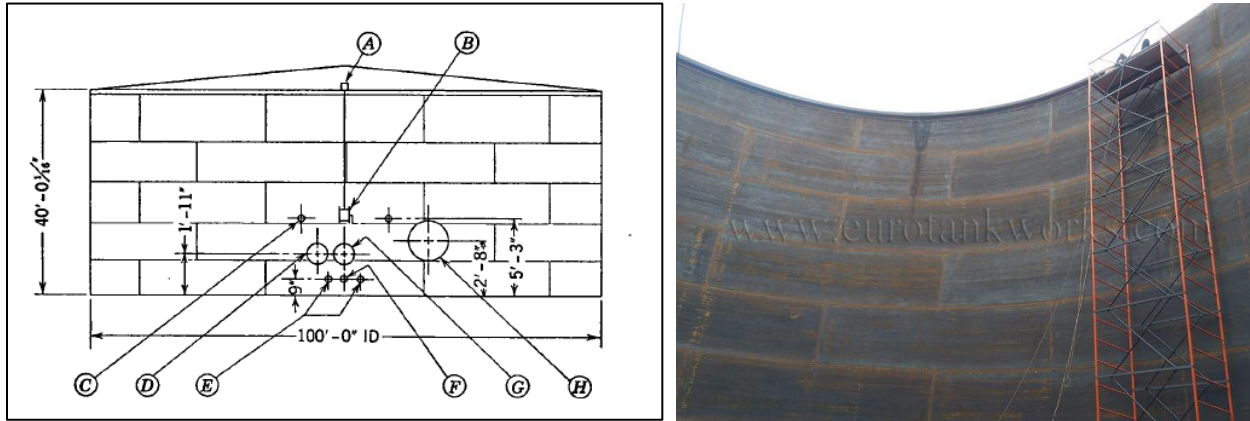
Esquema de Instalación Planchas del Manto (Traslapadas).
